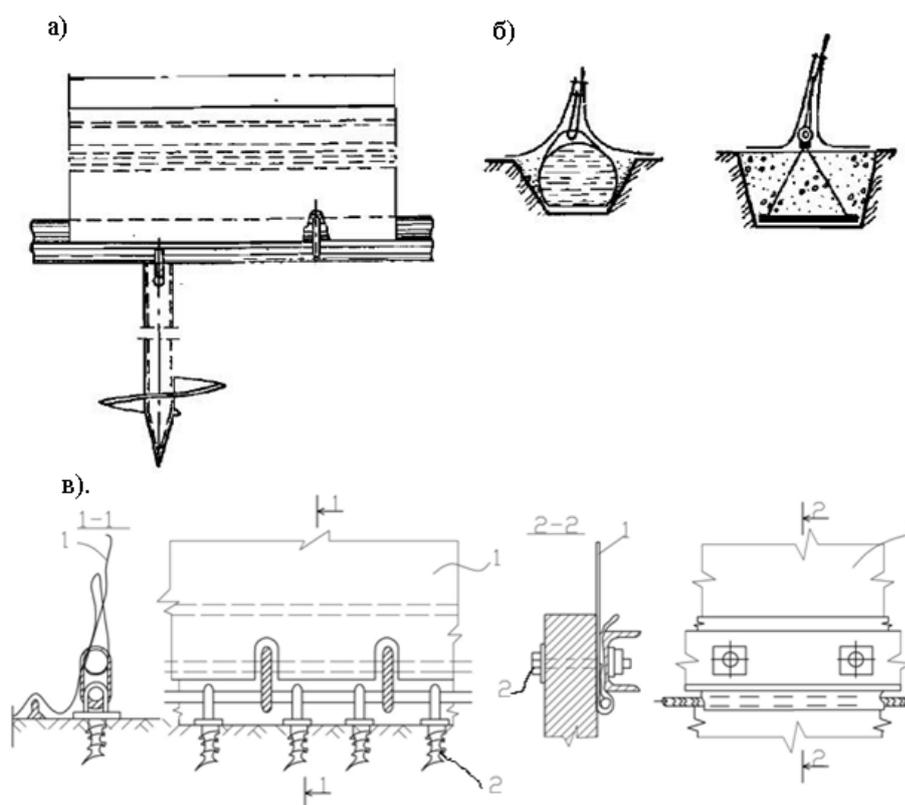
Анкерное устройство пневматических конструкций: а) - с креплением канатом; б) - с креплением рукавов, заполненных водой или земляных анкеров; в) - опорное устройство пневматической воздухоопорной конструкции: 1 - оболочка, 2 - анкер
